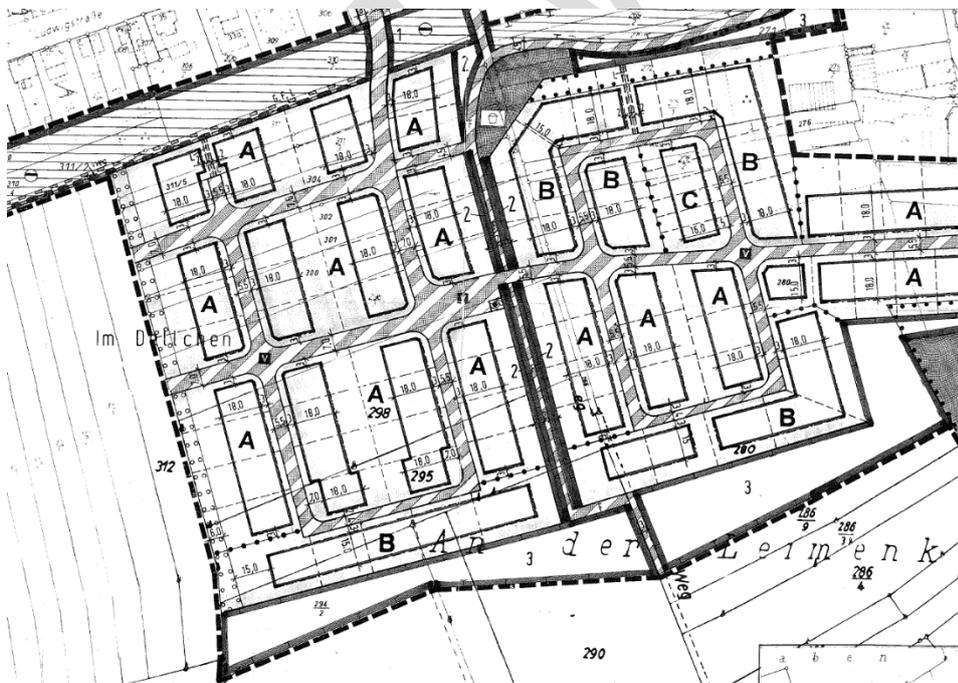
Bebauungsplan „Im Dellchen, 1. Änderung“
